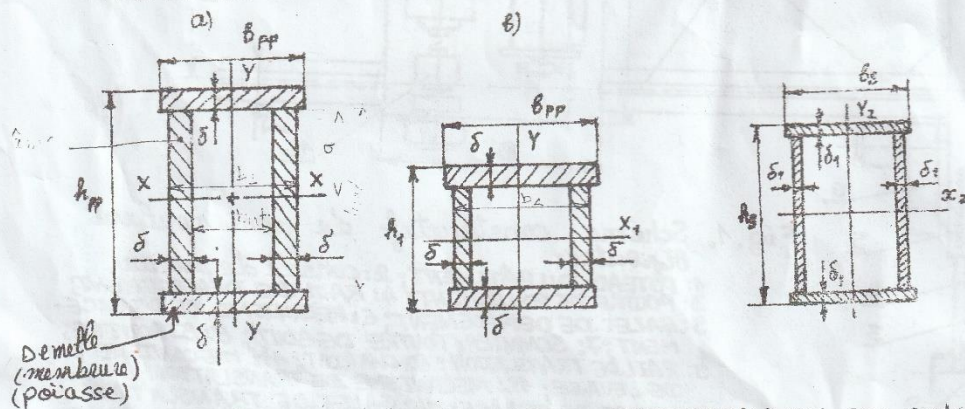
SECTIONS DE LA POUTRE PRINCIPALE ET DU SOMMIER:
